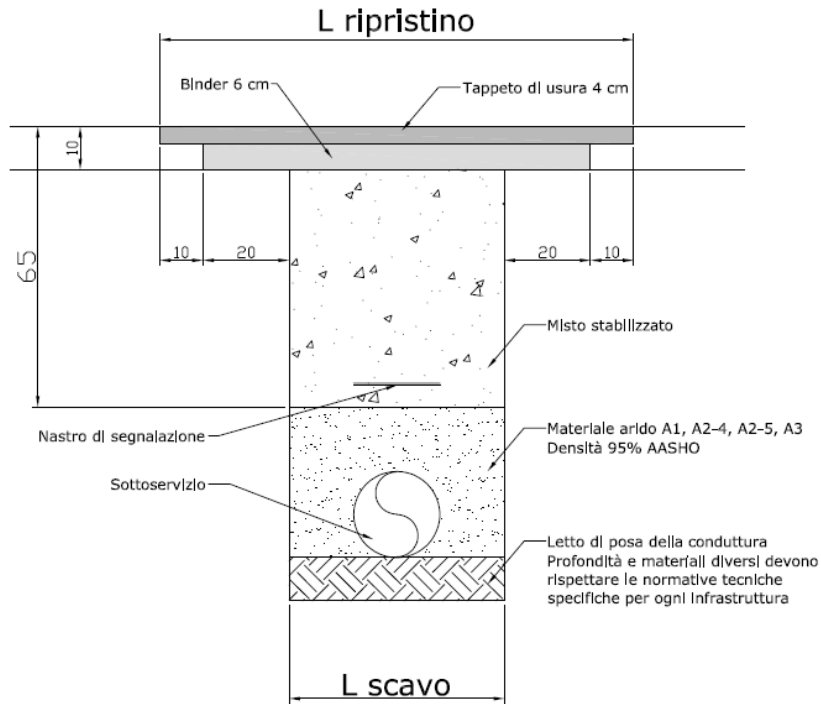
Posa su strada con pavimentazione in conglomerato bituminoso (rilievo locale) per allacciamento idrico e fognario
